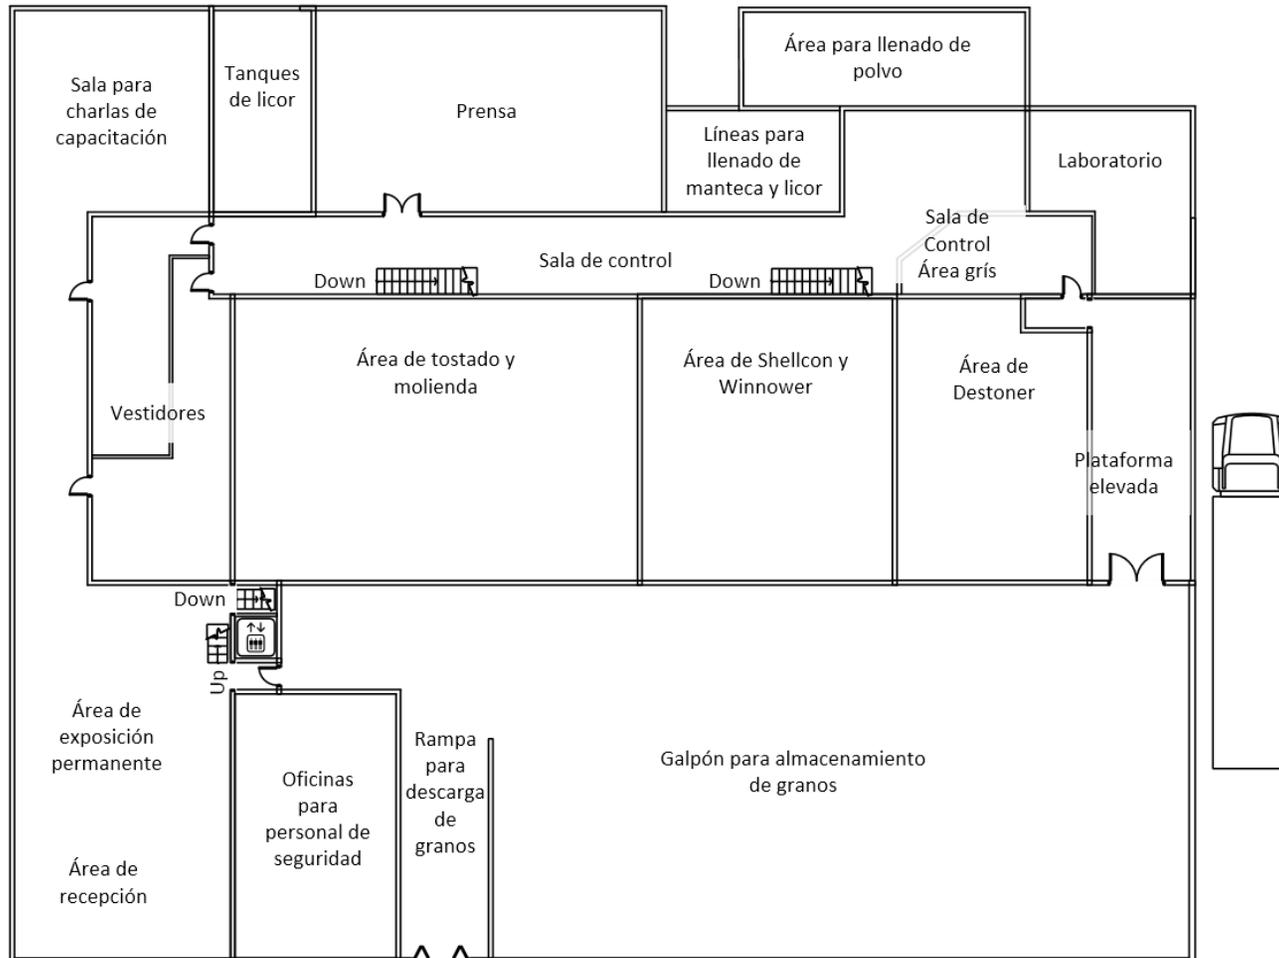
1: Plano de planta con ubicación de salas de control.
